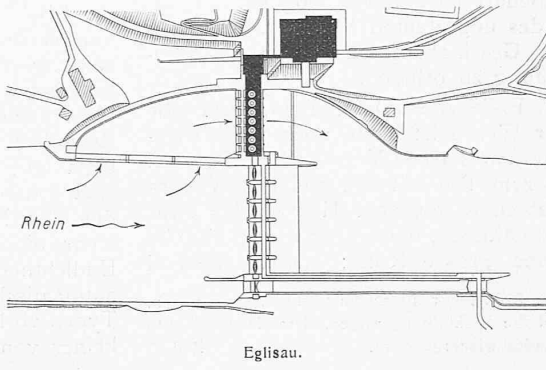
Reine Stauanlagen. — Lagepläne 1 : 7000.
